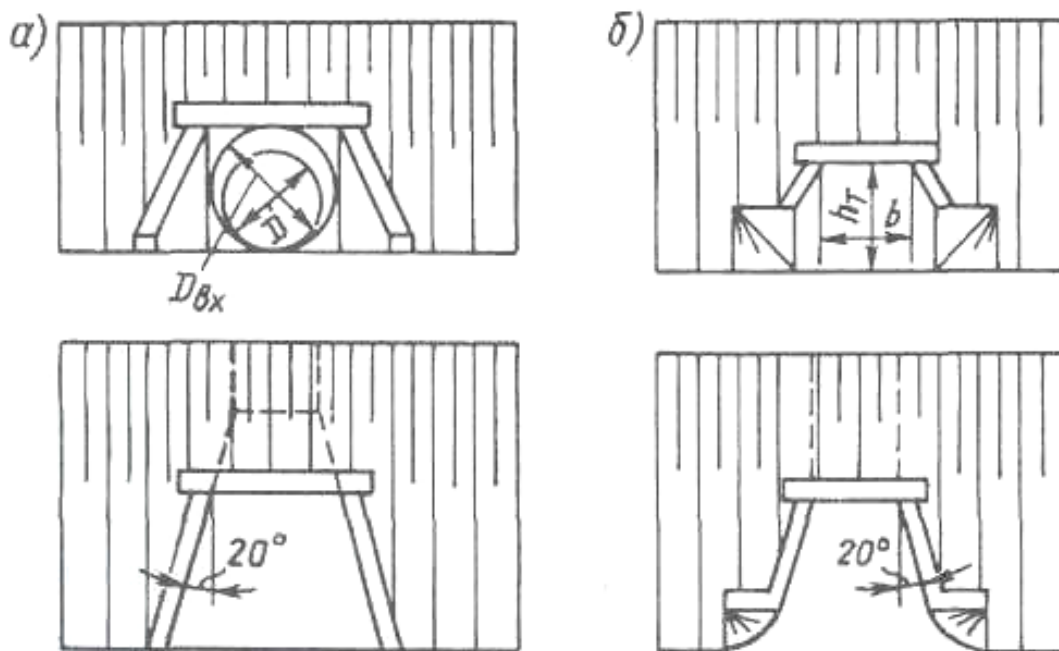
Типи залізобетонних і бетонних труб (фасад і план):
